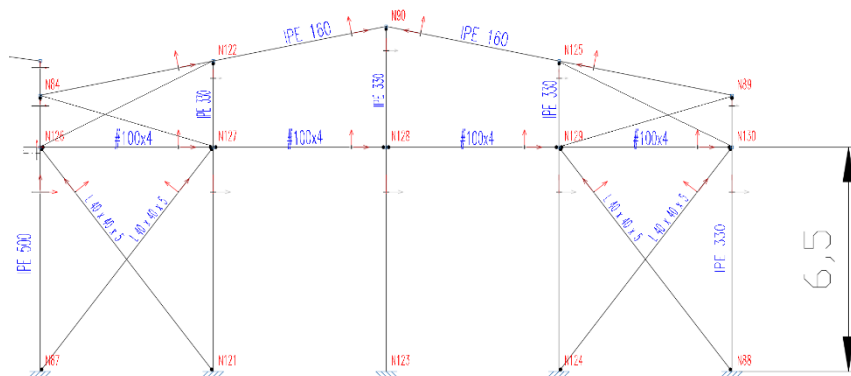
Pórtico de fachada principal de la nave secundaria con detalle de perfiles y nudos
